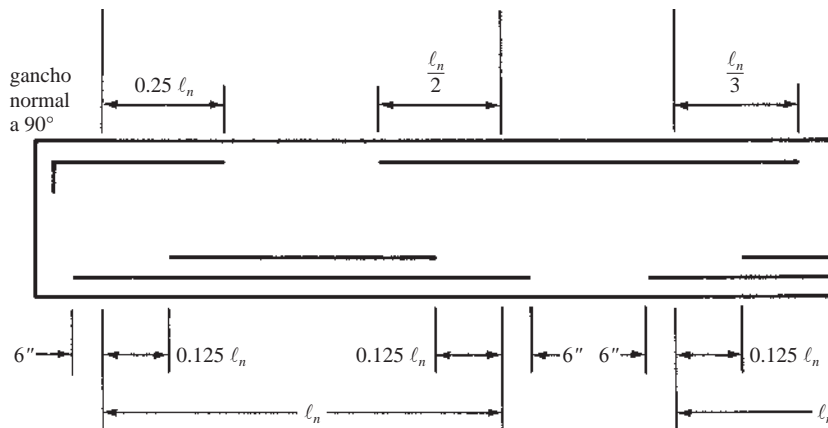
Detalles recomendados en varillas de vigas continuas.
